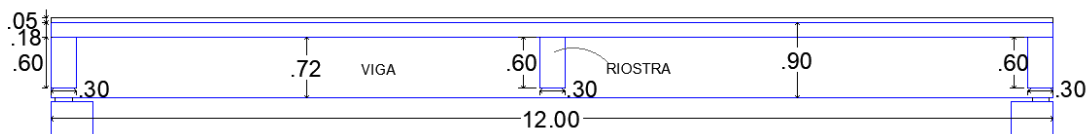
Corte longitudinal de la estructura de un puente de concreto reforzado de 12 metros (ver anexo 02 página 04)
